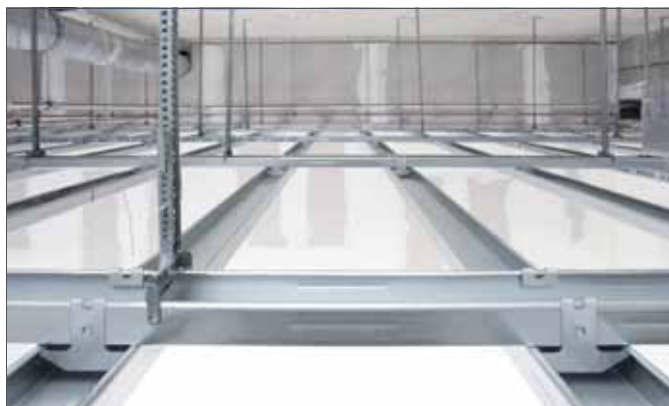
Крепление несущего каркаса поперек длины плит
